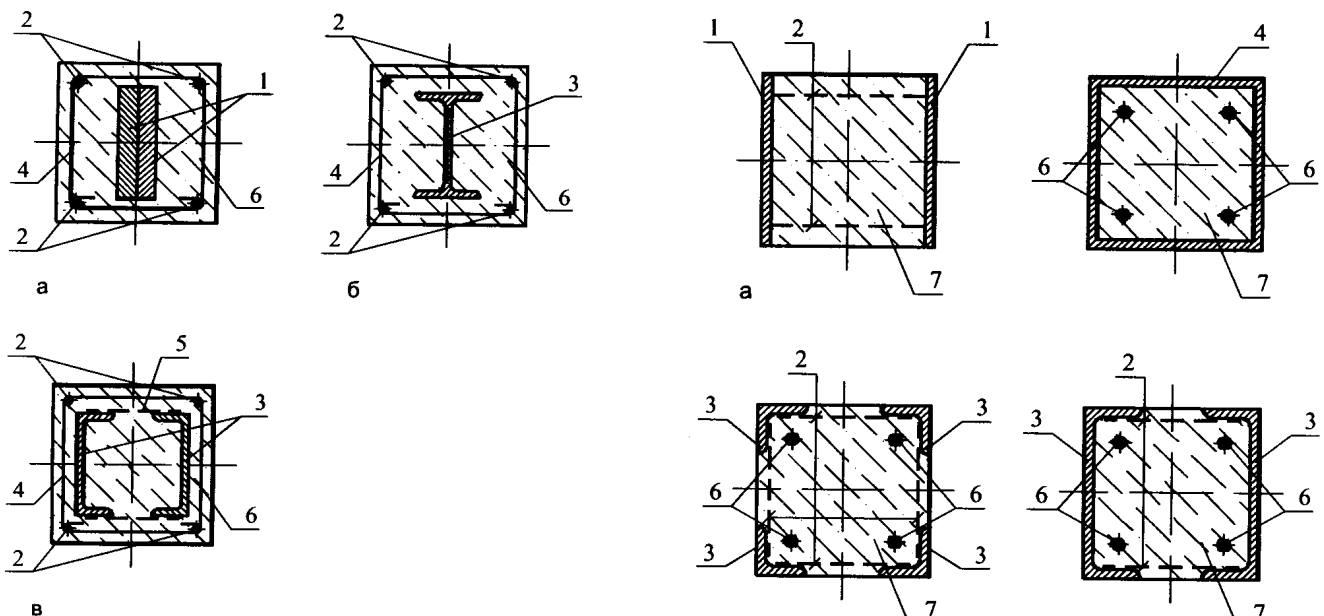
Поперечные сечения сталежелезобетонных колонн с внутренним расположением жесткой арматуры в сечении
